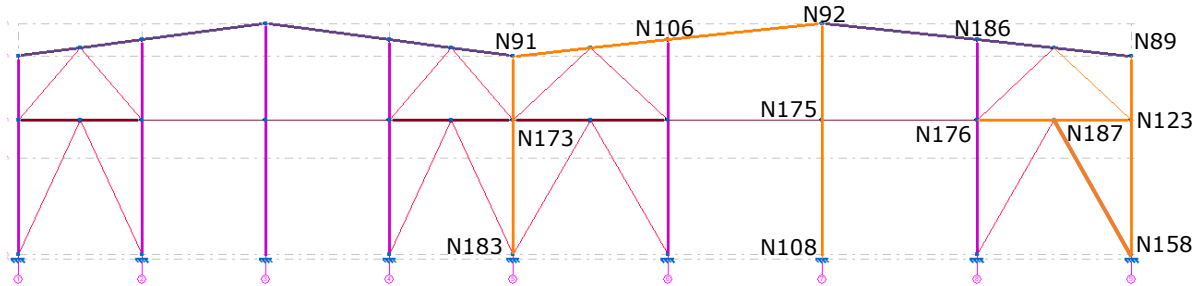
A. Selección de barras del pórtico de fachada tipo.
